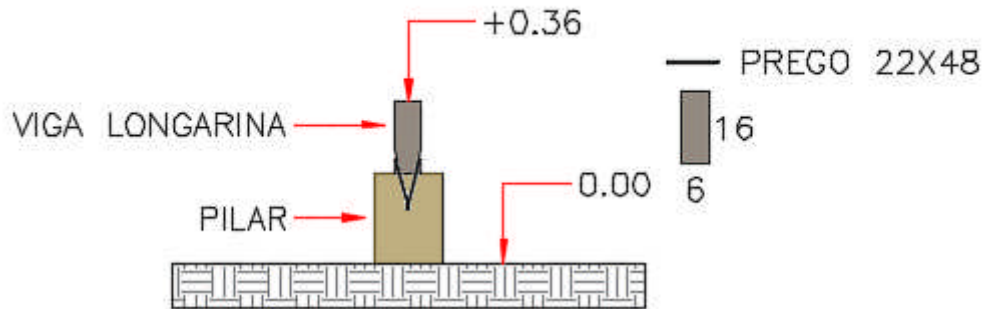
ESQUEMA DA FUNDAÇÃO DOS PILARETES
